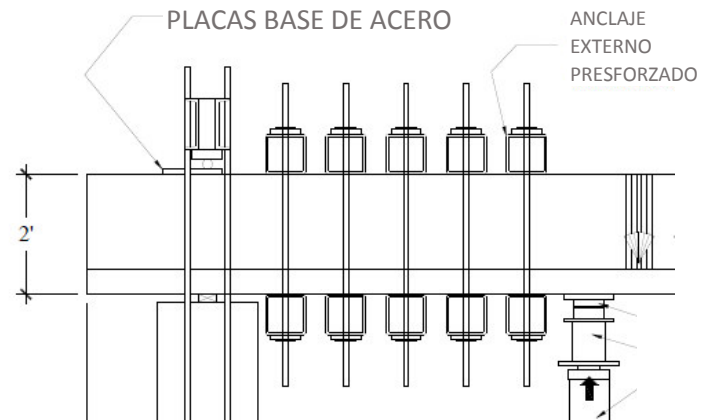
Ejemplo de vigas reforzadas con tendones o pernos postensados [Kim et al. 2011].
